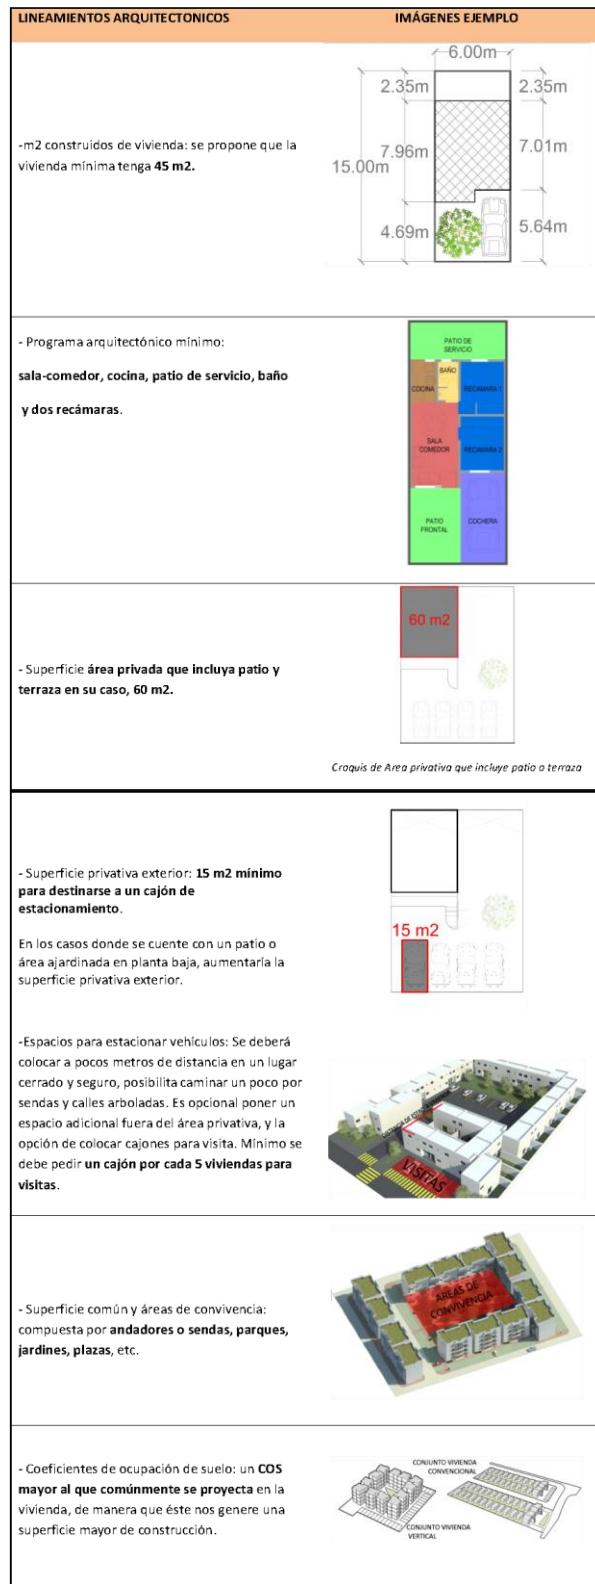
Lineamientos arquitectónicos para la vivienda
